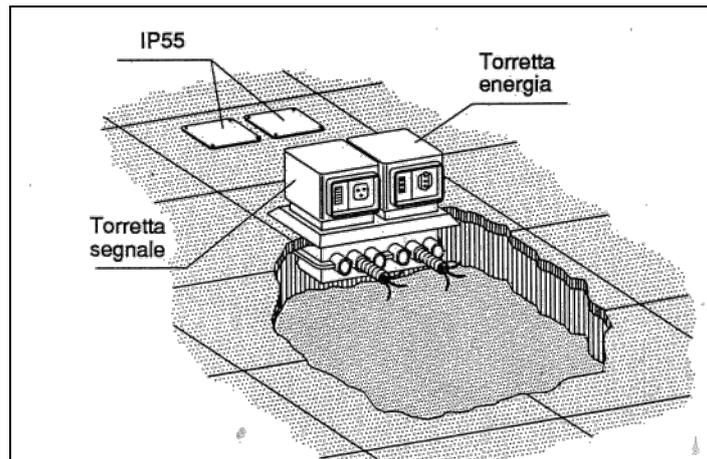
tubi protettivi di sezione circolare incassati nel pavimento
